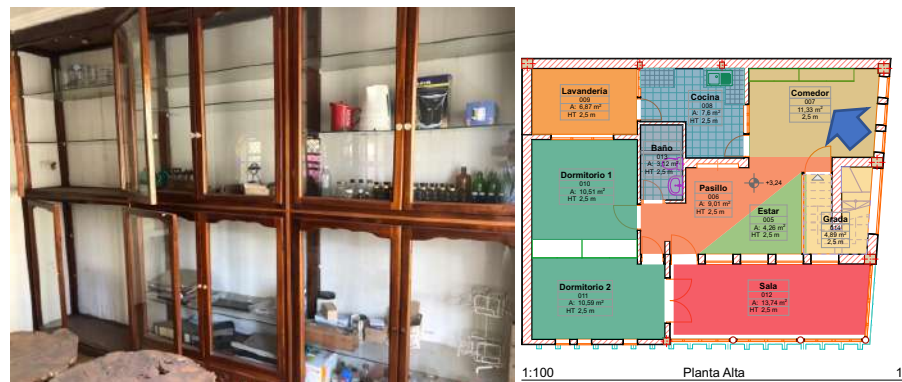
Vista vitrina existente en área de comedor / Autor, 2023
